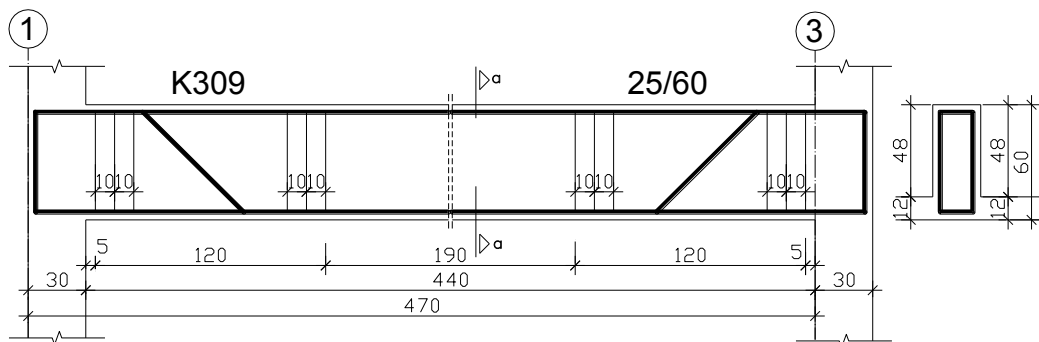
Ters kiriş donatı ve donatı açılımı
